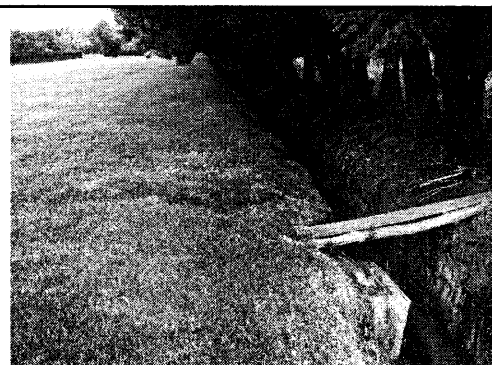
Punto de vertimiento sobre canal en tierra de la diagonal 237
